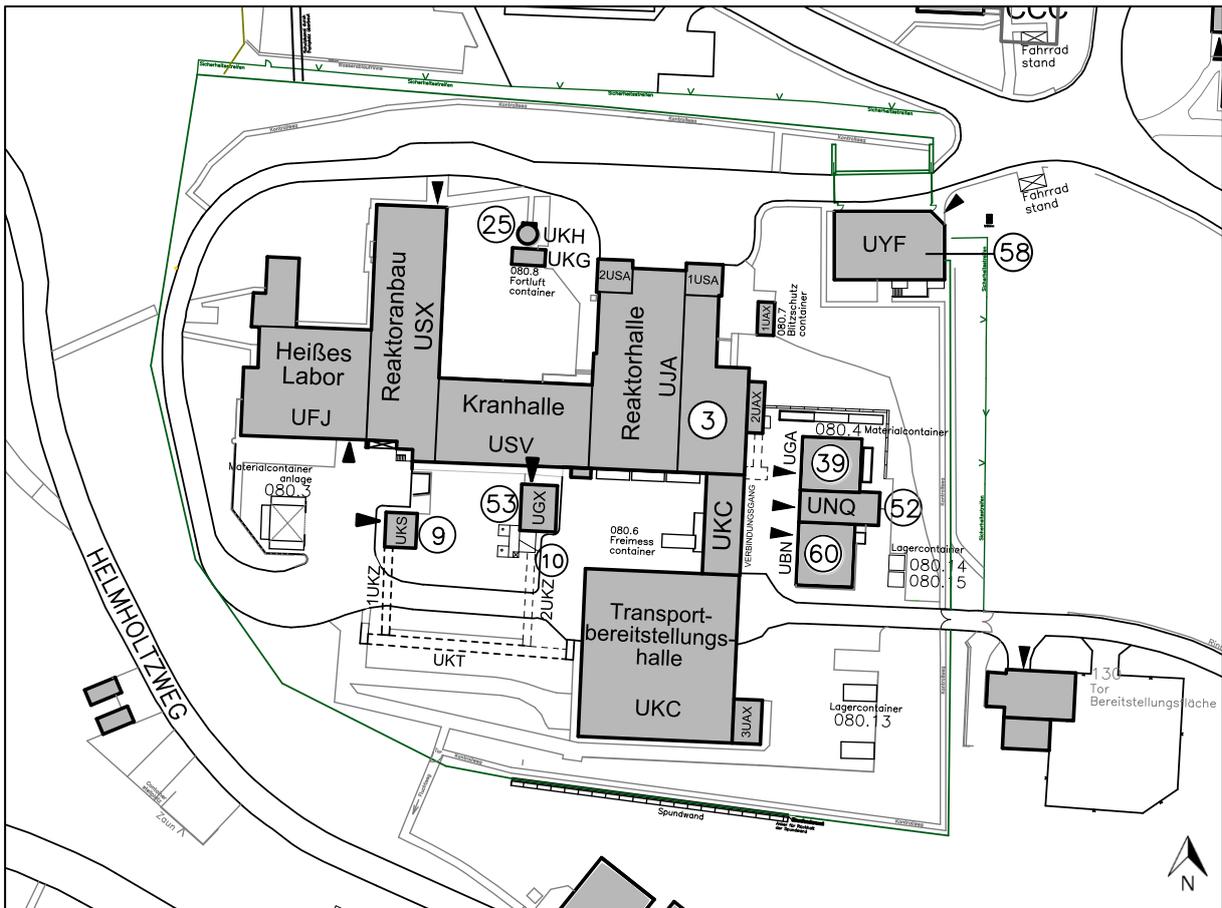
Lageplan Gebäude und Anlagenbereiche der Betriebsstätte FRG/HL
